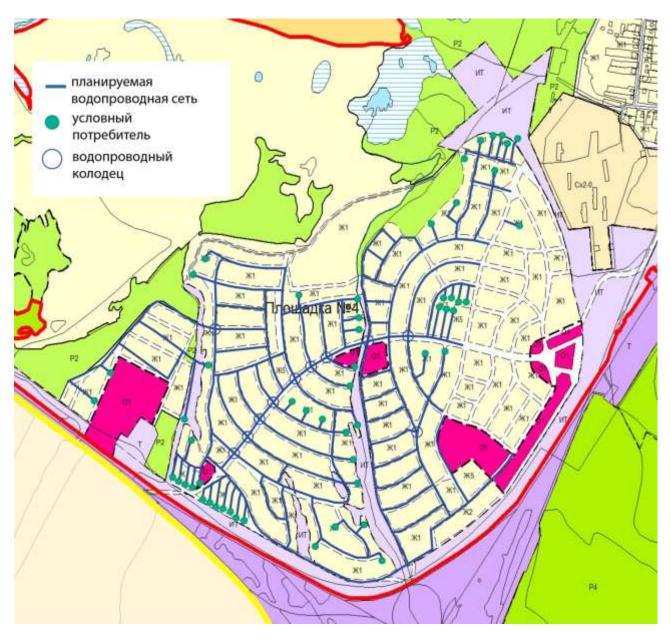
План перспективного расположения системы водоснабжения с. Белозерки (площадка N24)
